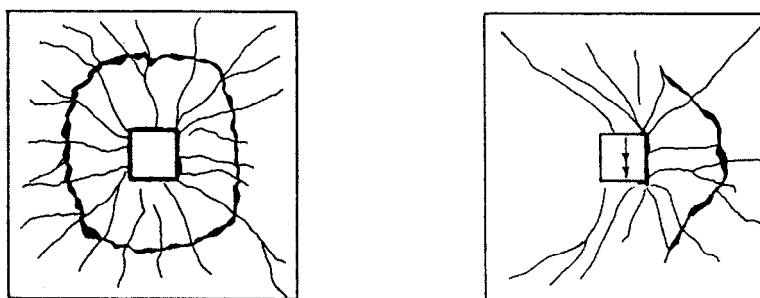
Etat de fissuration et fissures de poinçonnement à la rupture (vue en plan de la dalle). A gauche force verticale uniquement, à droite moment de flexion uniquement [Krüger99]
